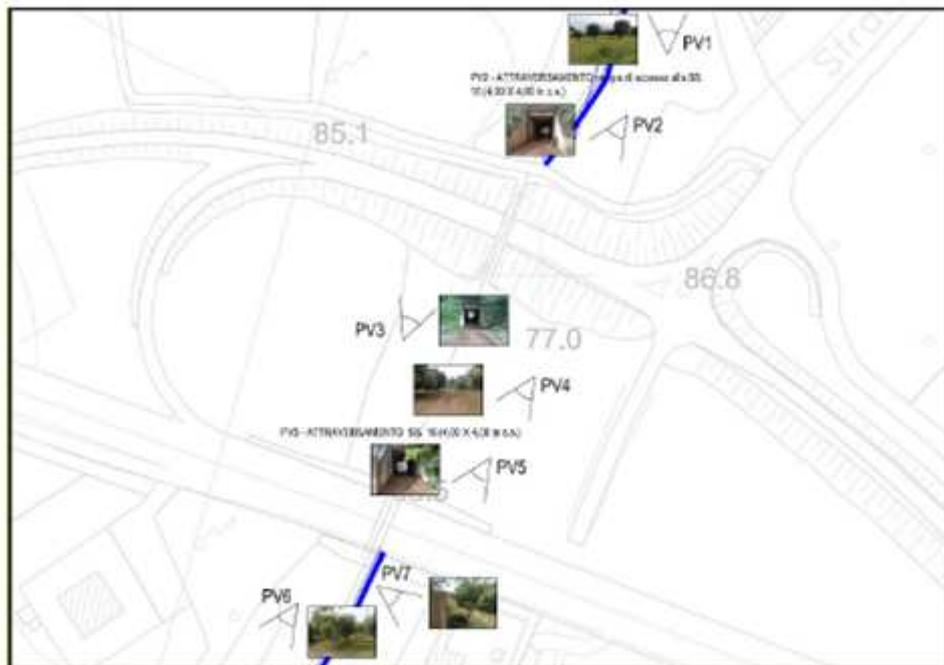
Planimetria con ubicazione degli attraversamenti della SS16 e svincolo.
